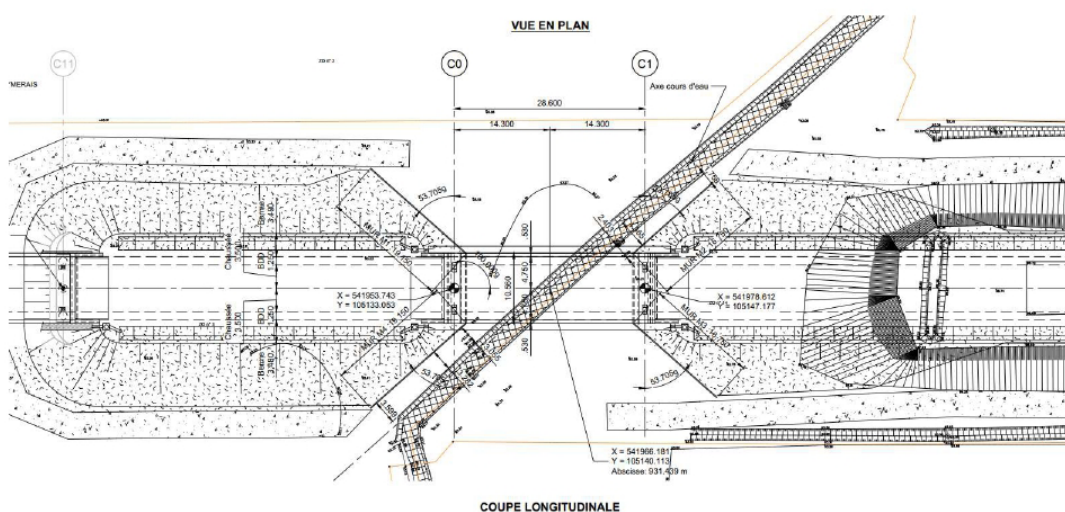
extrait de la vue en plan de l'ouvrage de décharge permettant le franchissement du Coulis
